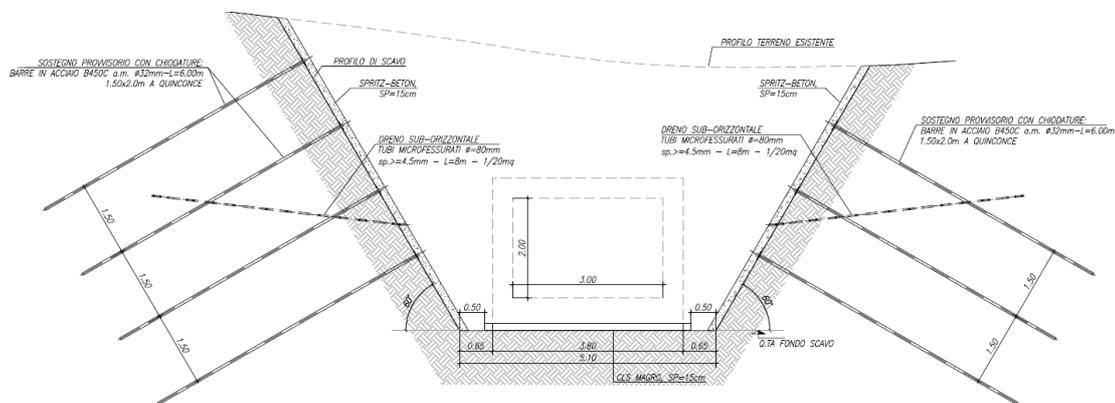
Tombino idraulico: sezione tipo scavo con chiodatura e spritz beton con rete e.s.
